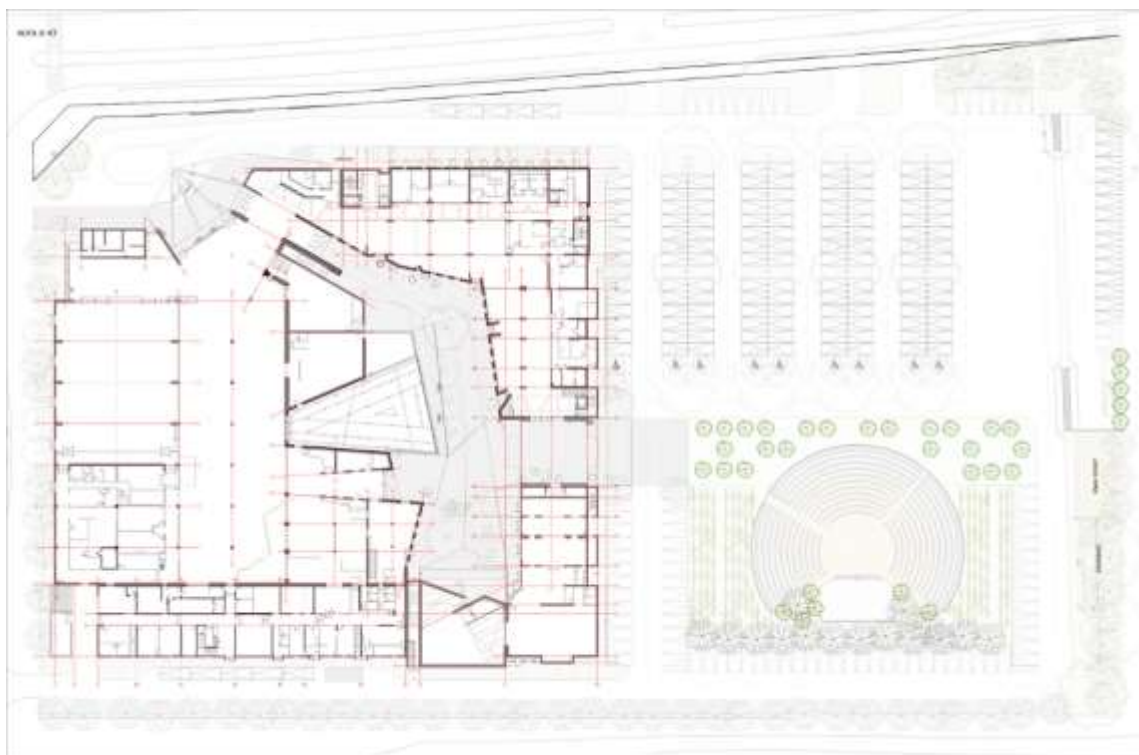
Планування 1-го поверху та генеральний план [27]
